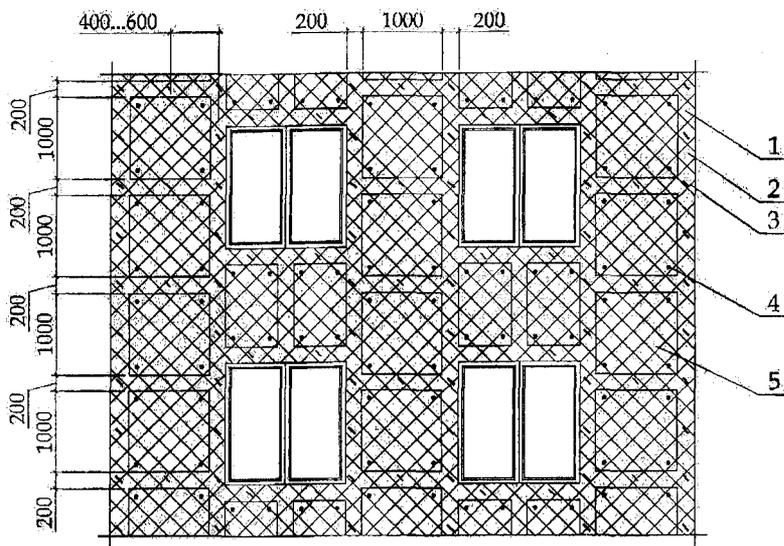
Схема крепления пенополистирольных плит и армирующей сетки: 1 – поверхность изолируемой стены; 2 – армирующая сетка; 3 – петля крепления сетки с дюбель-гвоздем; 4 – дюбель-анкер; 5 – пенополистирольная плита
